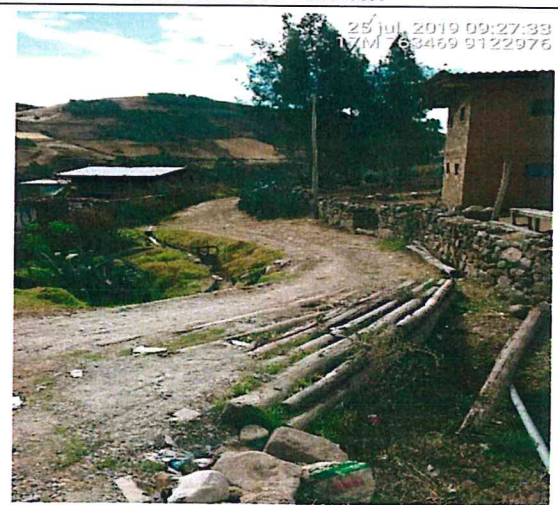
Trocha carrozable apoyado con troncos de madera, sobre quebrada seca.
